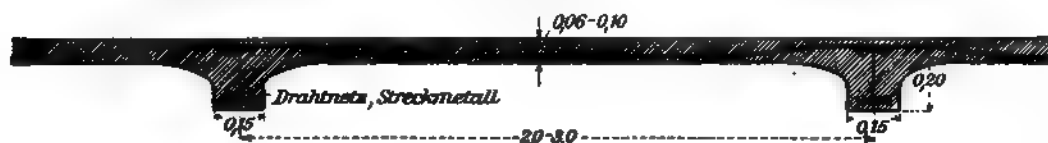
Eisenbetonhaut zwischen eisernen Pfetten.
